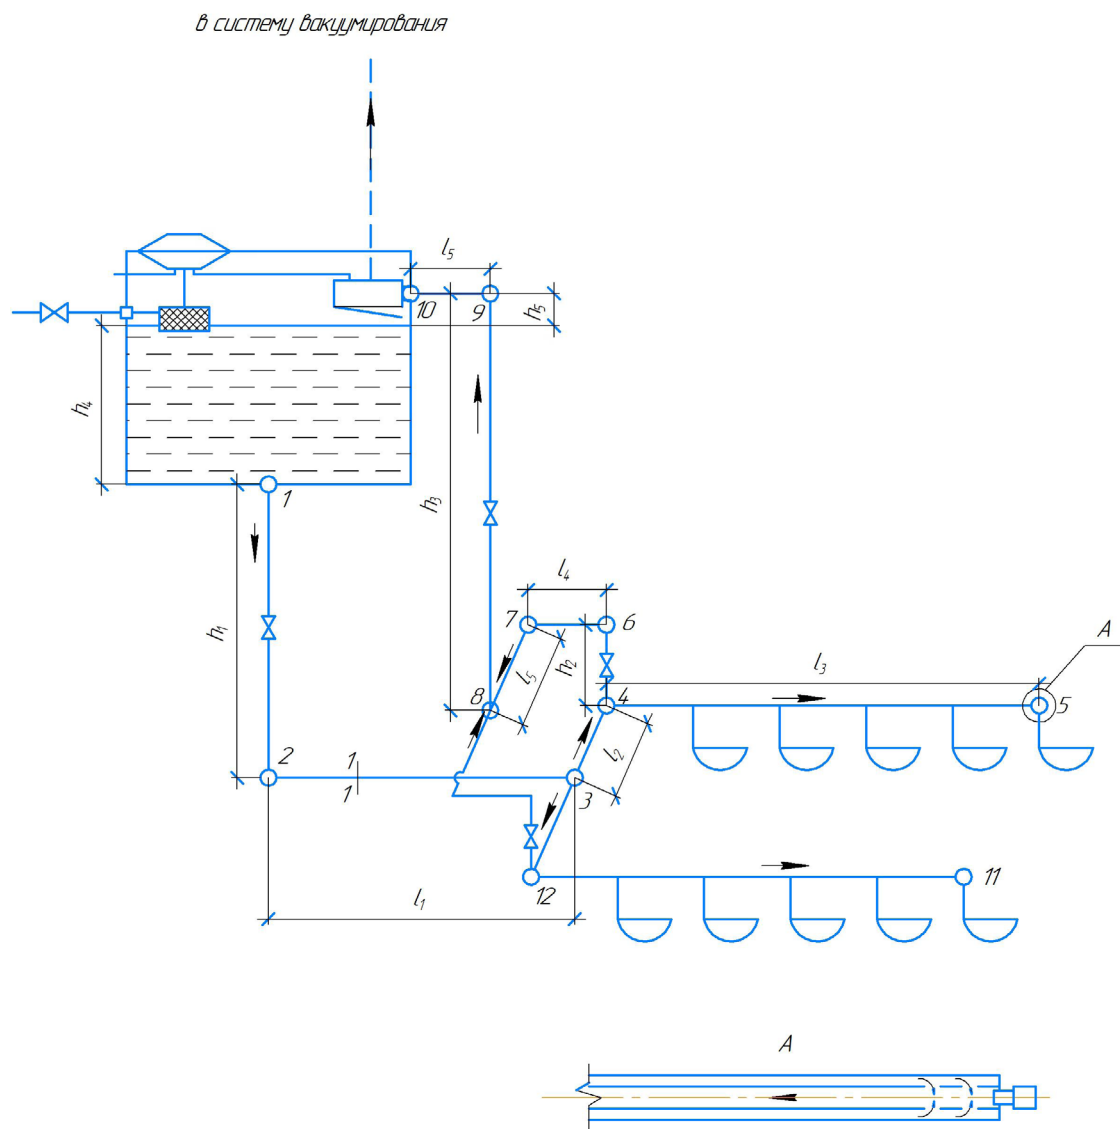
Расчетная схема усовершенствованной подсистемы поения КРС на откорме
